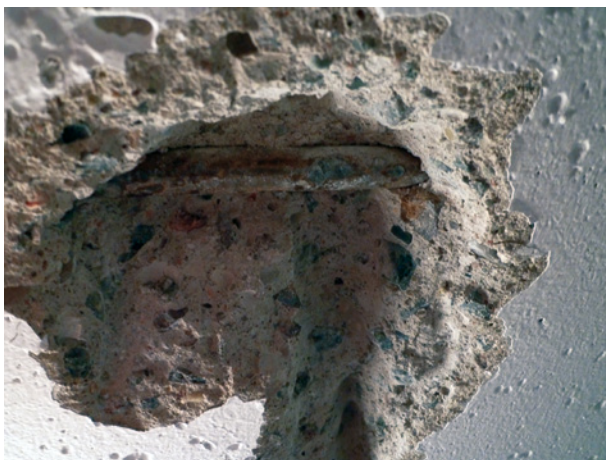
■ Fehlerhaft beurteilte Stahlbetondecke
